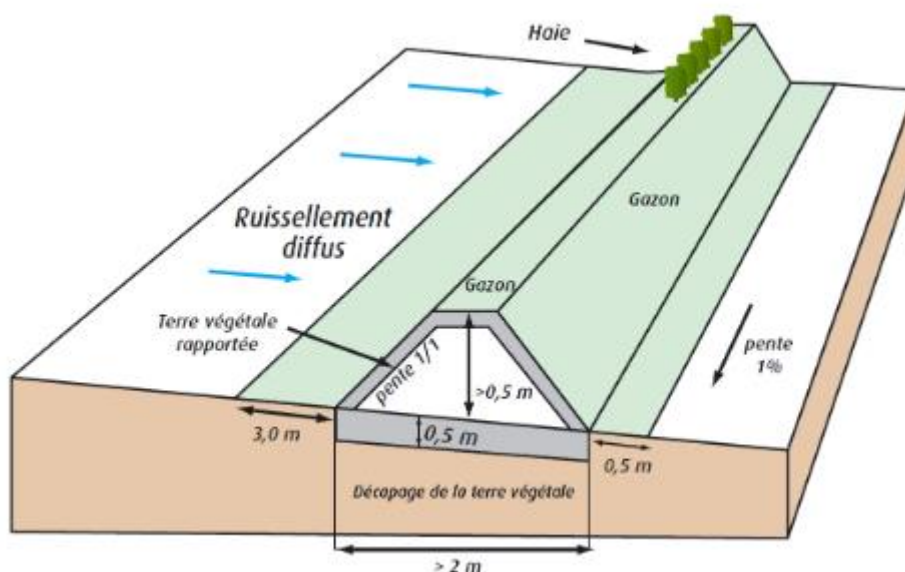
Coupe type d'un merlon planté (source : AREAS)
